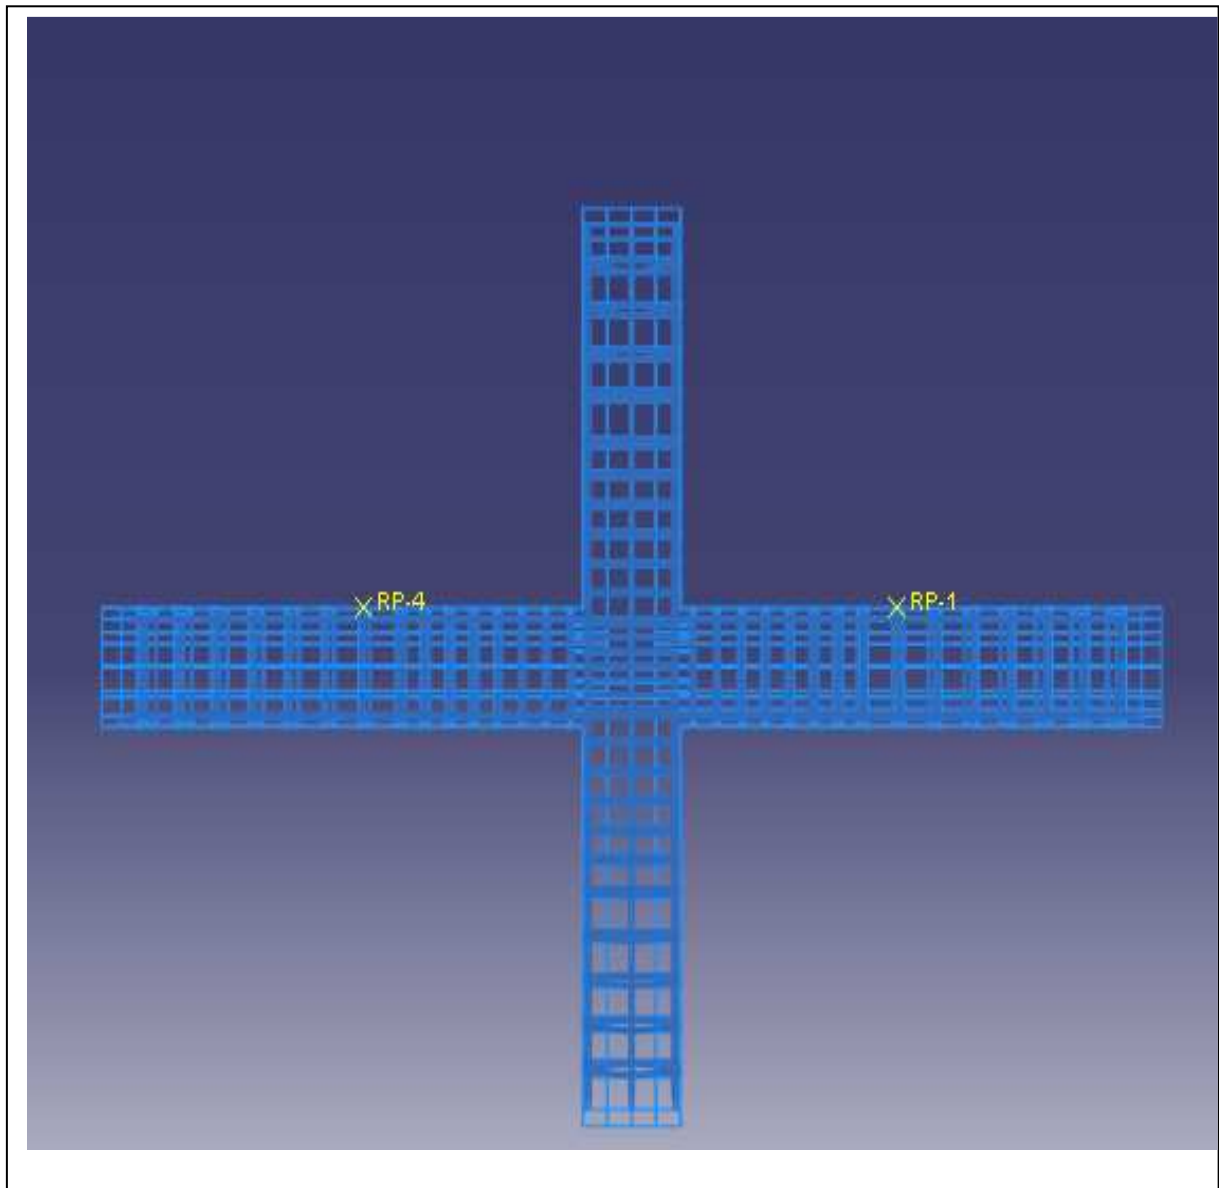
Ferrailage du nœud poutre- poteau renforcé
